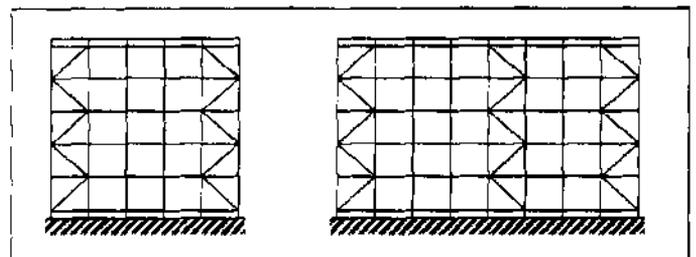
Contreventement : exemples de solutions avec croix de Saint-André.
